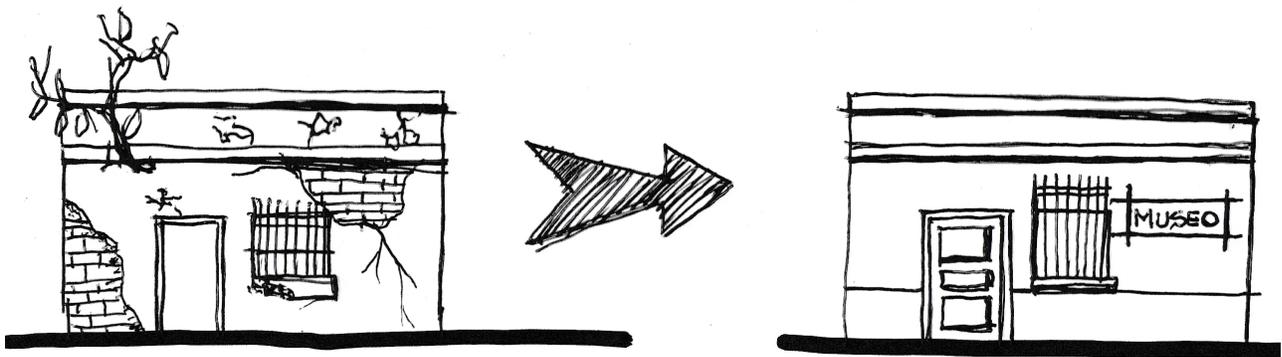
Esquema que ejemplifica la intervención a fachadas dañadas y deterioradas. Elaboración: Propia
